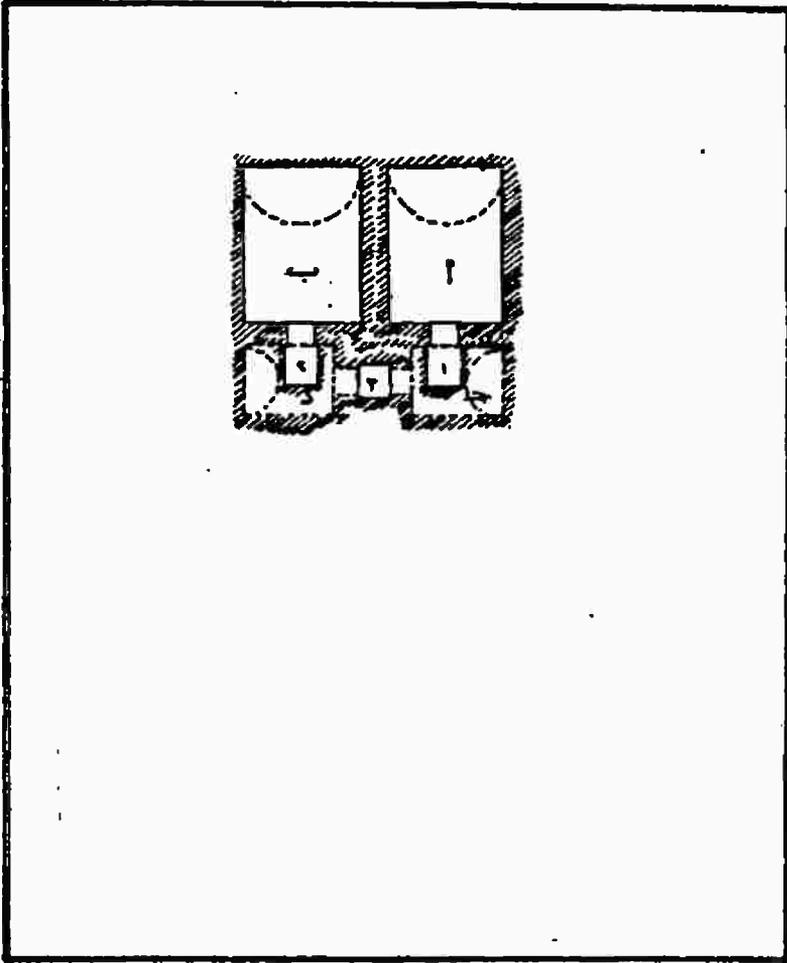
مسقط أفقي لقبة الخلفاء العباسيين بالسيدة نفيسة
